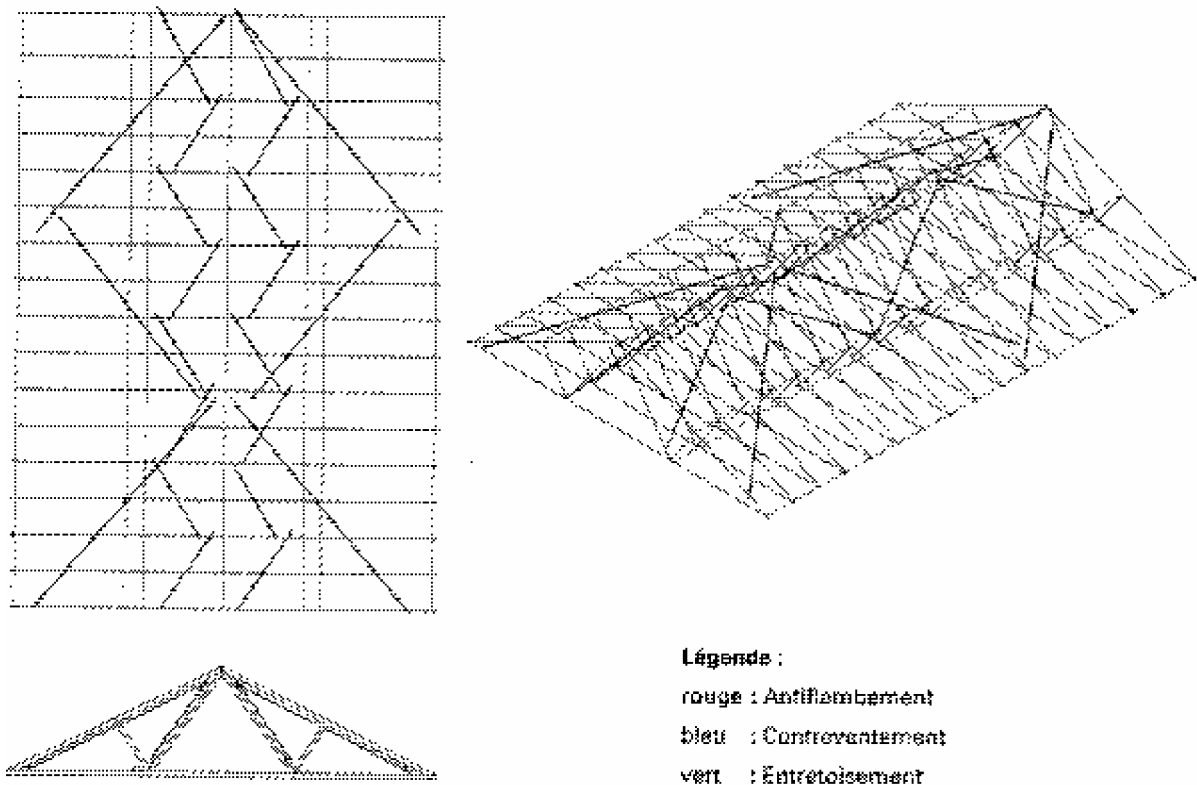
Charpente de comble perdu - Exemple de disposition des barres d'antiflambement et de contreventement
